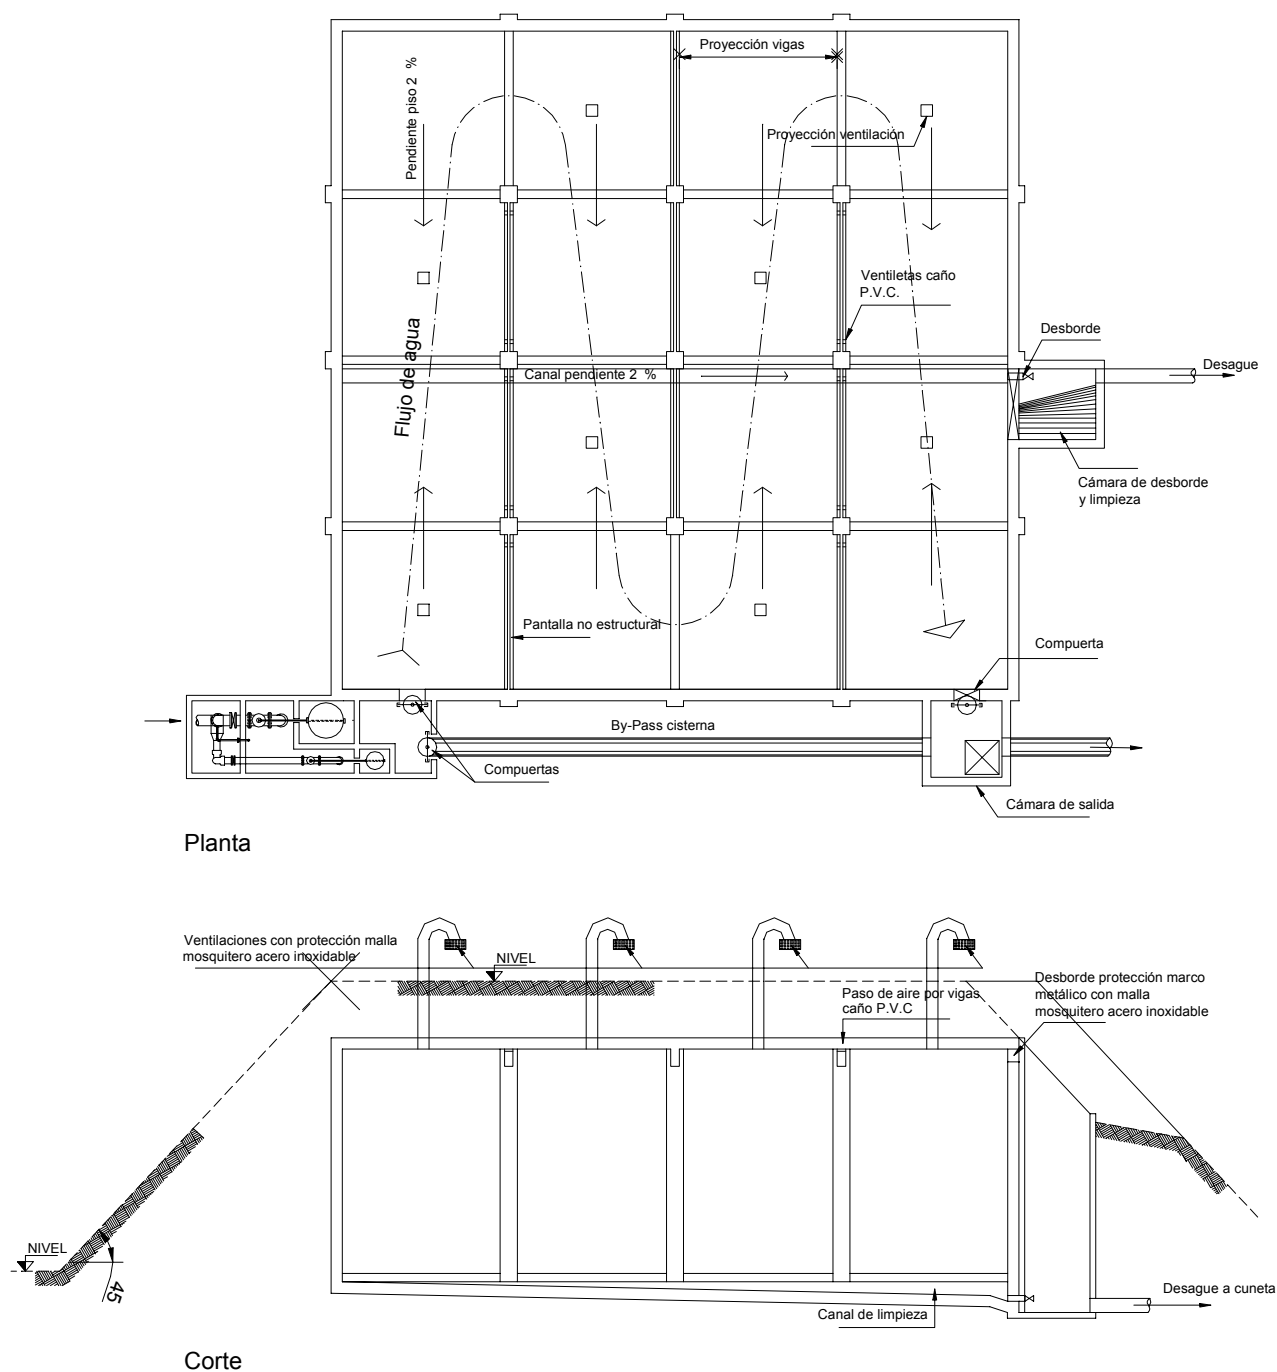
Cisterna con cámara rompecarga - Planta y corte
